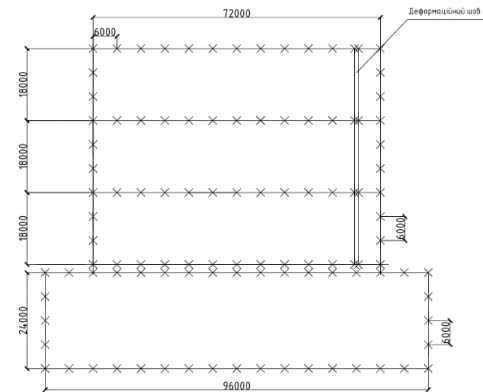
Схема будівлі Рис.3.2 Схема розташування колон та підкранових балок
